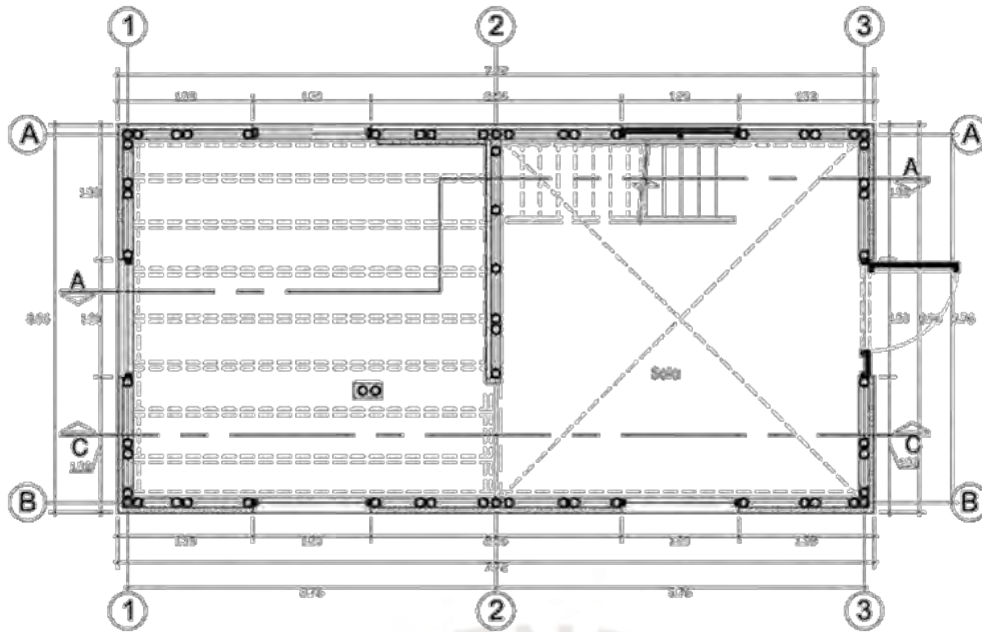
Plano de planta del primer nivel de la casa voces por el clima
